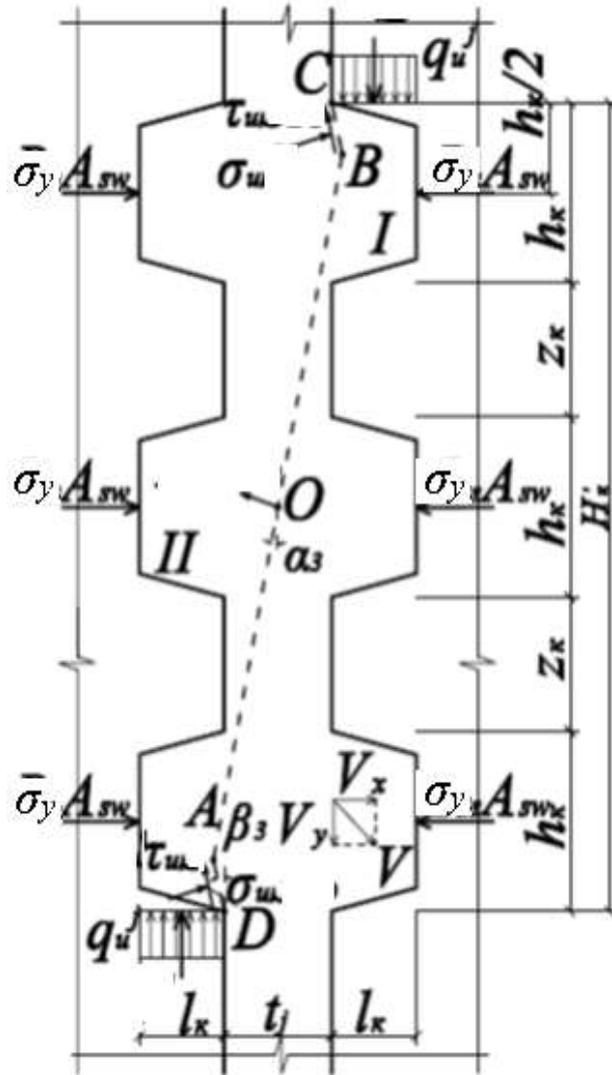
Кінематично можлива схема руйнування залізобетонних трьохшпонкових стиків трапецієподібного профіля при руйнуванні за швом
